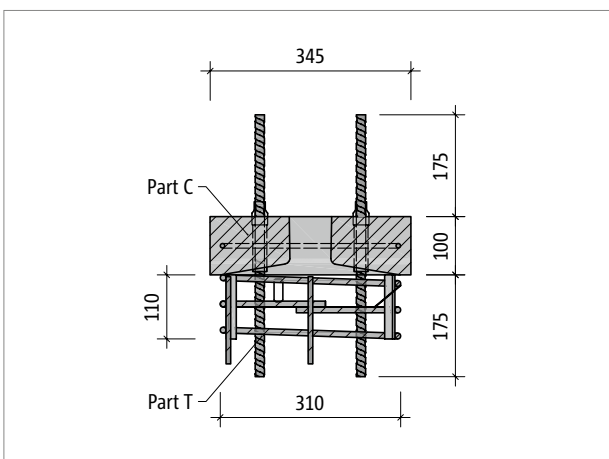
Schöck Sconnex® type P-B350: Aanzicht van bovenaf
